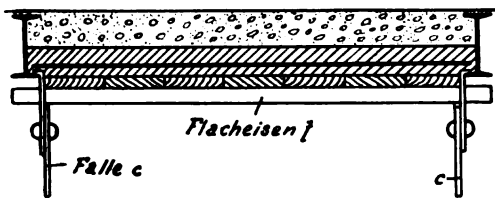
Einschalung mit Stiepers Gerüsthalter.
